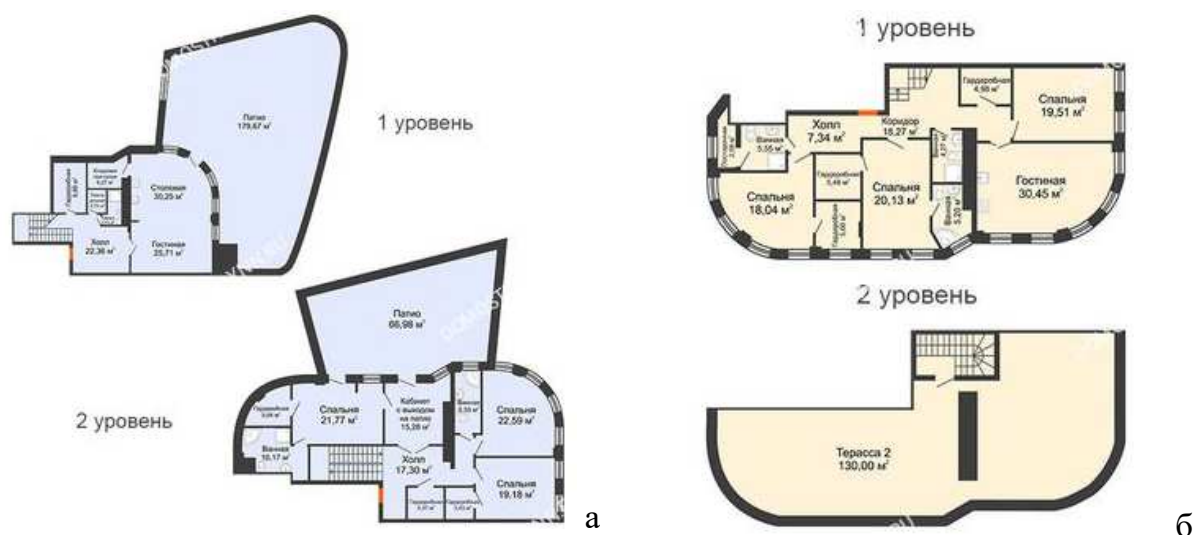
ЖК Плотничий, Нижний Новгород [3]: а – двухуровневая квартира с 2 террасами (180 м<sup>2</sup> и 67 м<sup>2</sup>); б - квартира с эксплуатируемой кровлей (130 м<sup>2</sup>) на крыше 8 этажа
